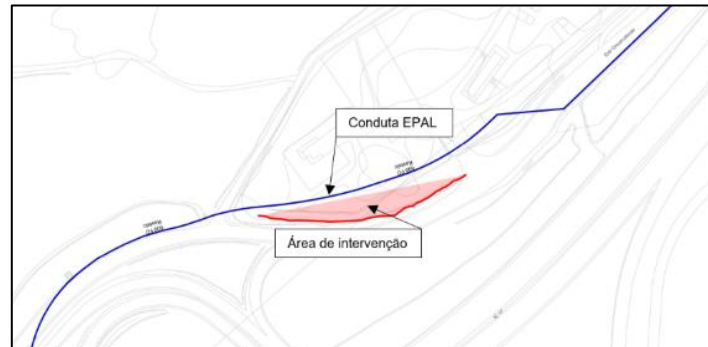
Cadastro da Conduta da EPAL (troço 3)
